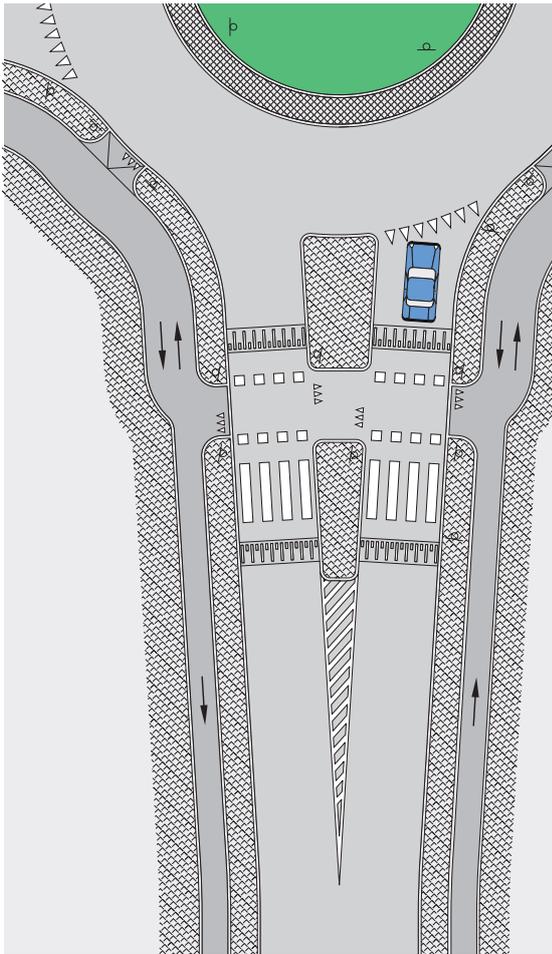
Piste cyclable bidirectionnelle traversant une branche sur un plateau, avec une jonction radiale sur l'anneau
